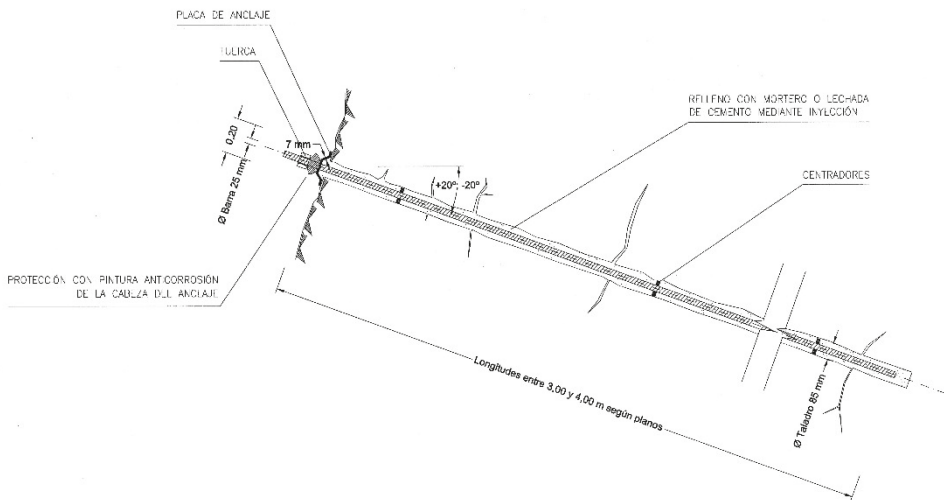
Detalle de anclaje pasivo adherente sobre talud en el macizo rocoso fracturado.
